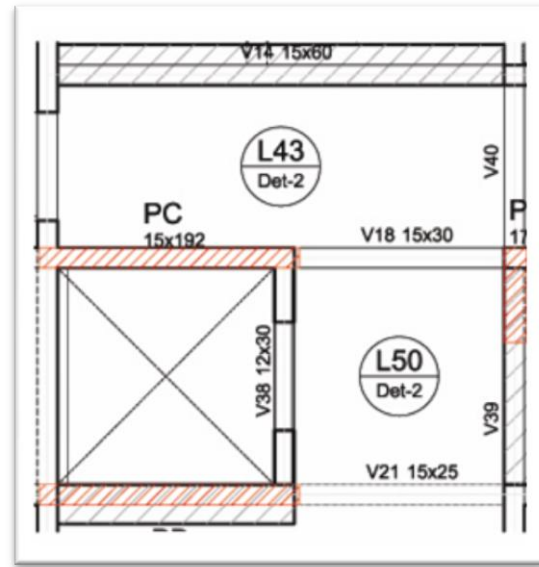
Planta baixa desalinhamento de pilar com parede.
